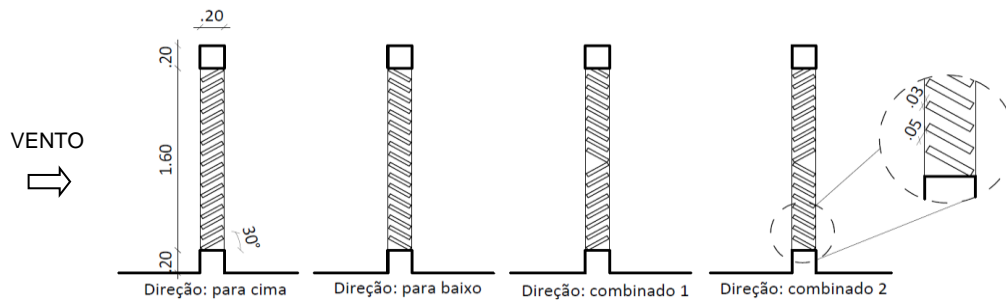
Cortes demonstrando as configurações do muro vazado com lâminas horizontais com inclinação de 30°.
